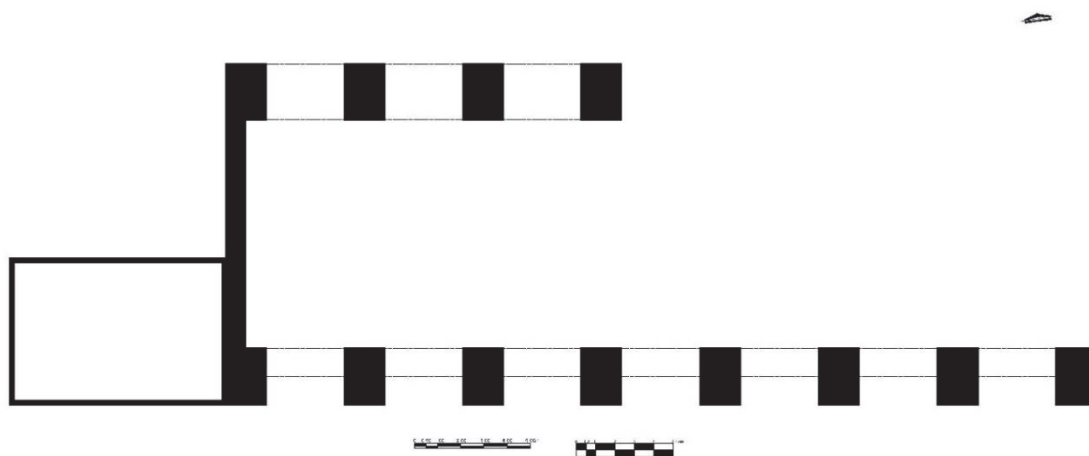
Planta del trapiche estado actual. Fuente: Elaboradas por Fernando Javier Flores Nájera
